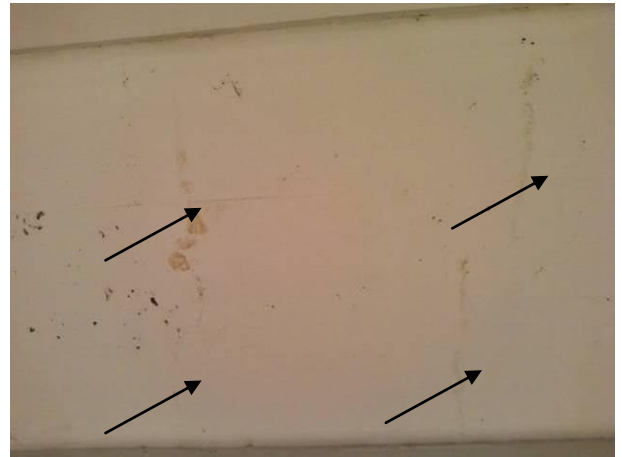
Fissuras transversais com abertura de 0,2mm na face inferior da Viga calha do eixo 13, entre eixos K/L.
